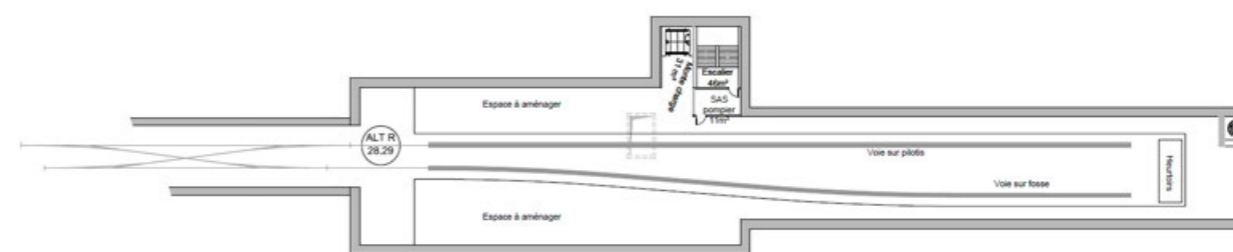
Plan du niveau inférieur du CDT (Source : RATP)
